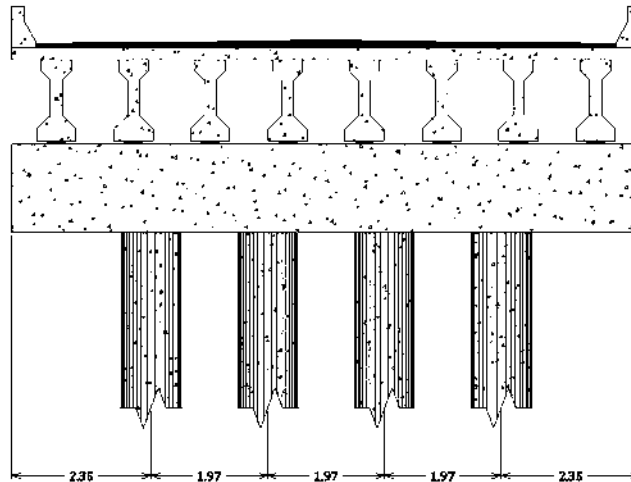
Espaciamiento entre columnas en pilas con altura $5 \leq h \leq 15\text{ (m)}$ (acotación en metros)
